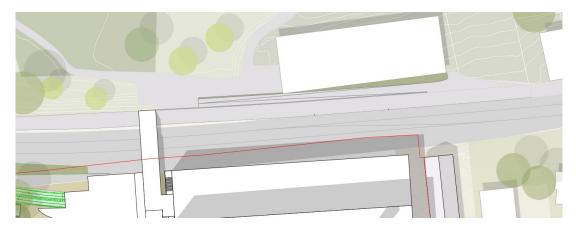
Anschluss Passerelle mit Rampe Alte Landstrasse gemäss Richtkonzept
